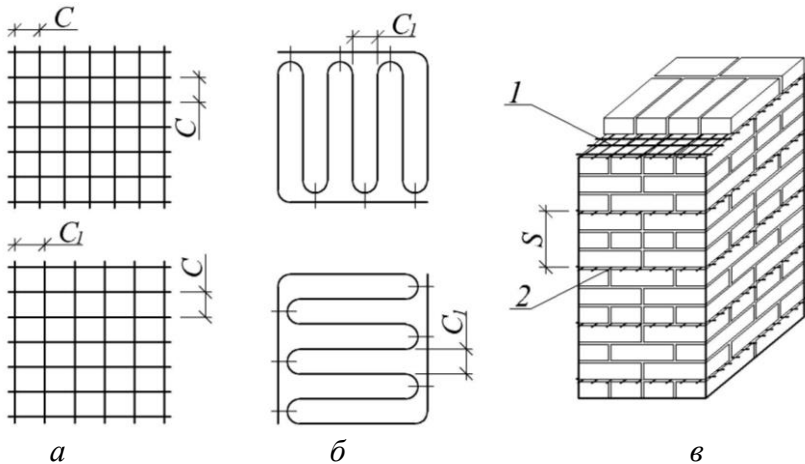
Сітки для поперечного армування кладки: *a* – сітки з перехресним розташуванням стержнів; *б* – сітки типу „зигзаг”; *в* – укладання сіток (1) з випусками (2) у шви цегляної кладки
